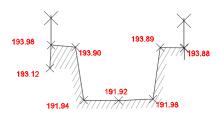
Section du canal au niveau de l'ouvrage de délestage du Tarze
